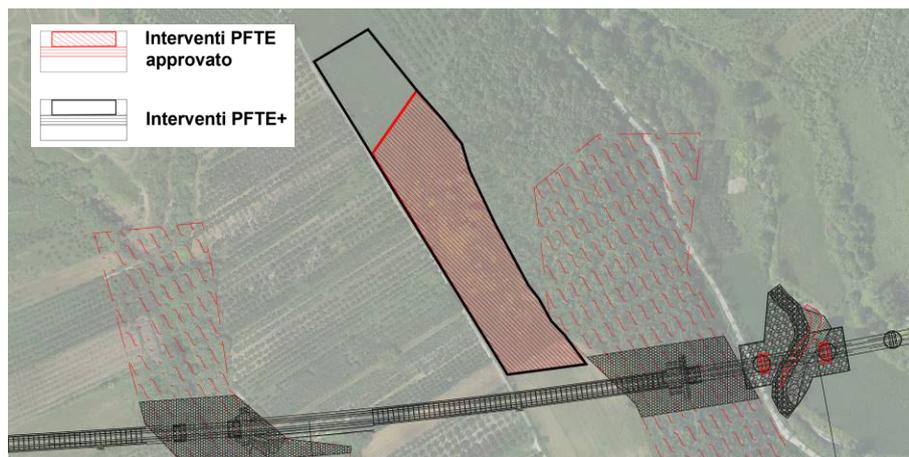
Modifiche all'area di cantiere AS.03. Sovrapposto cantieri con il sistema dei vincoli (in rosso il PFTE e in nero il PFTE+)
